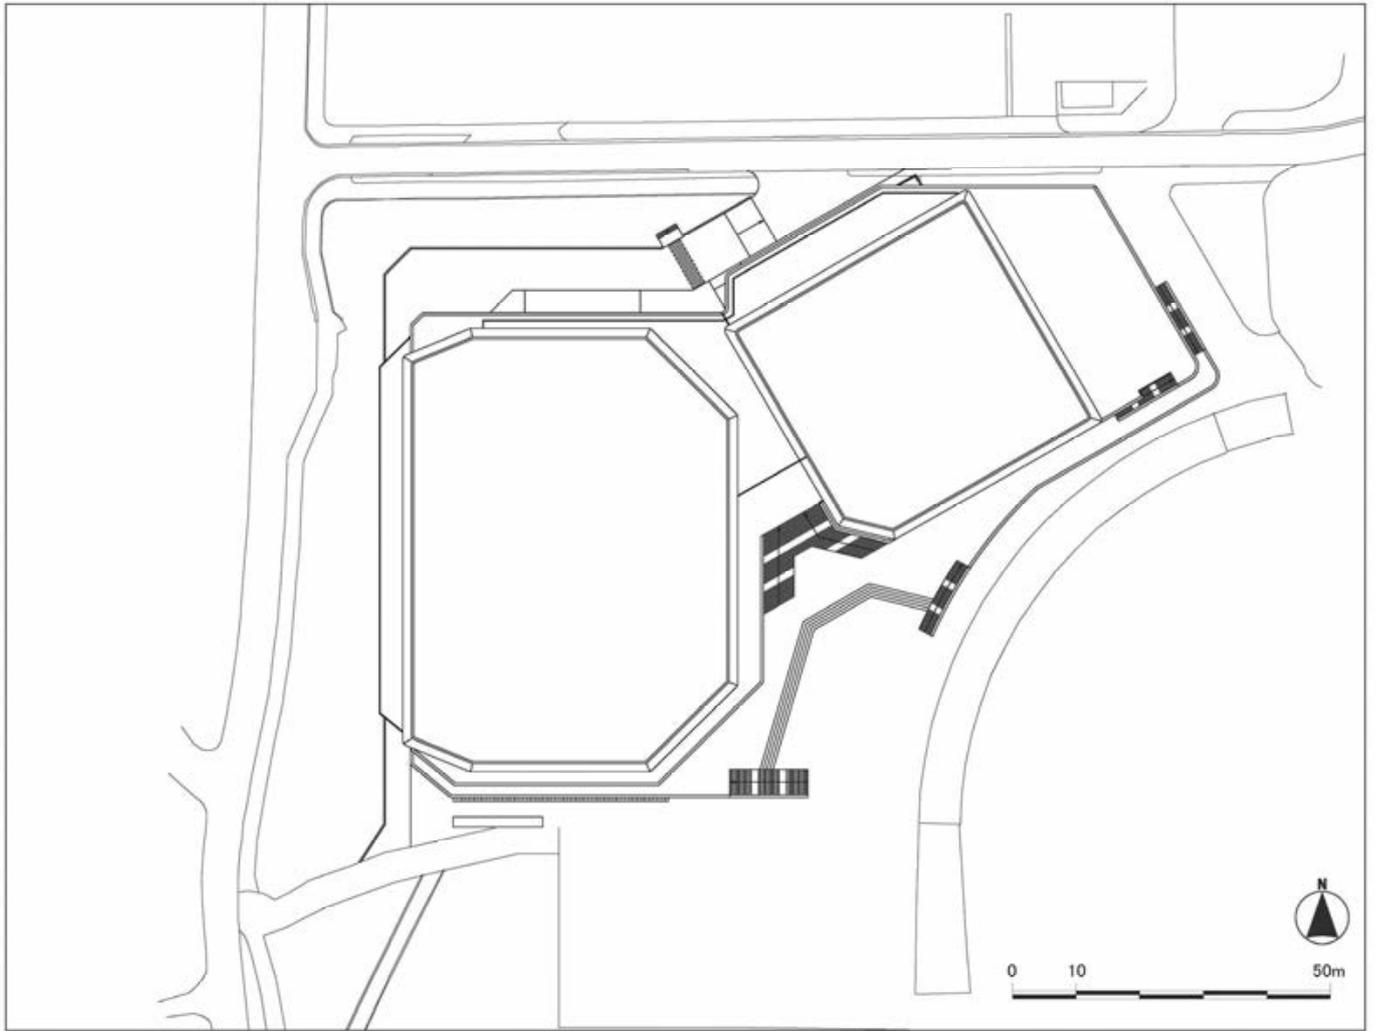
(10) (新) とどろきアリーナ・スポーツセンター平面図 (屋根伏 平面図)
